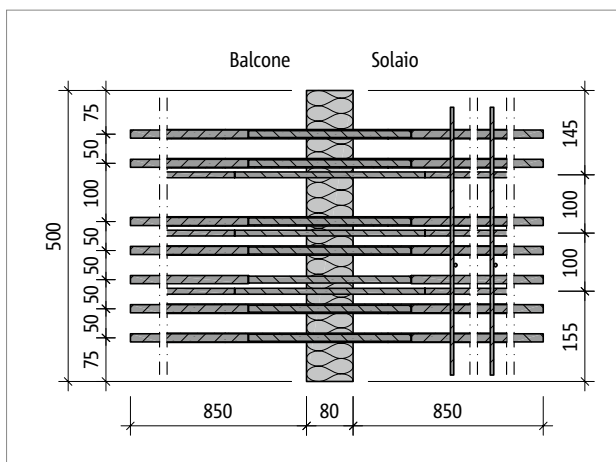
Schöck Isokorb® T tipo KP-M13-V1: pianta del prodotto
